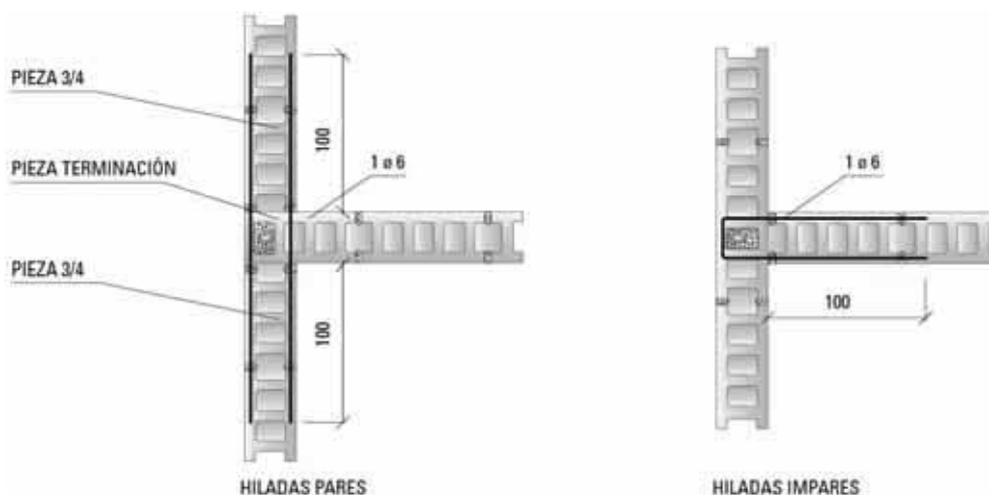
Refuerzo vertical y macizado en encuentro de muros de bloque hueco.
